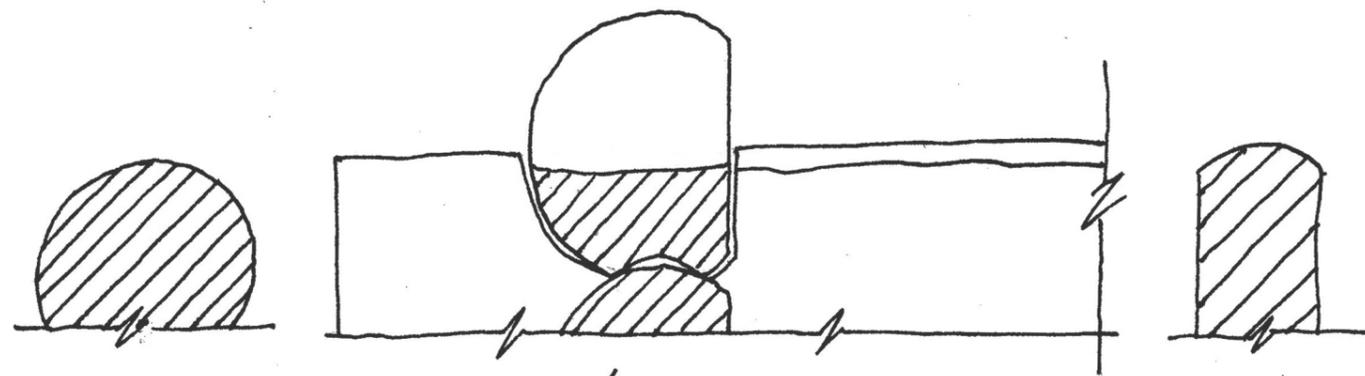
Переруб (внутренняя стена) между молельными помещениями.
